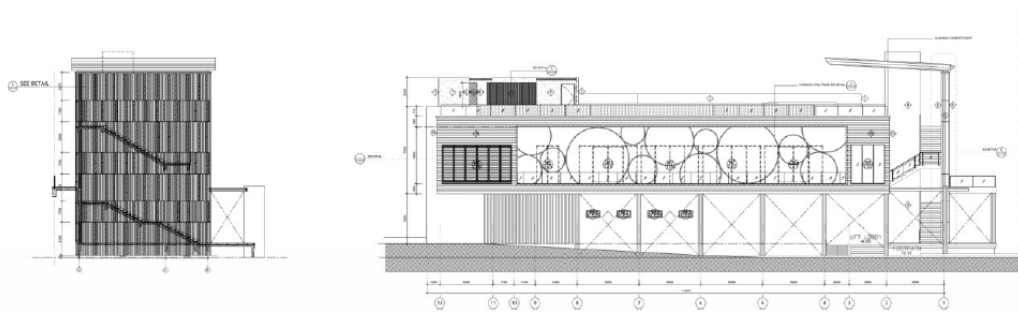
รูปด้านอาคาร Sport equipment
